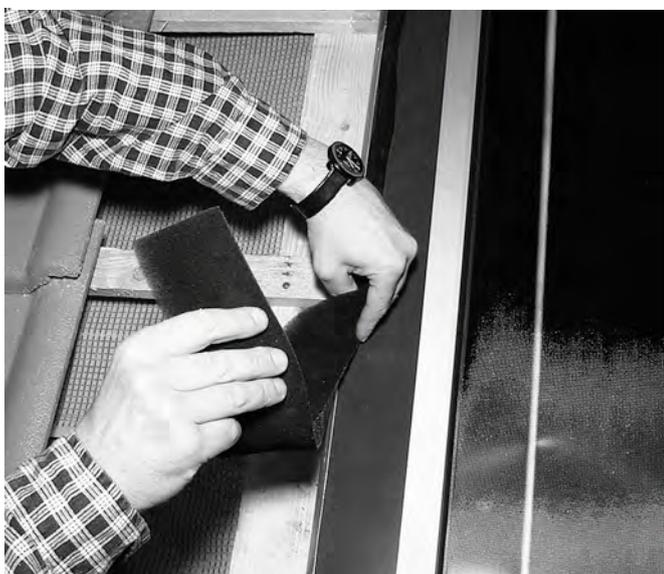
Collez également sur les profilés latéraux, le long du pli, une bande en mousse.
